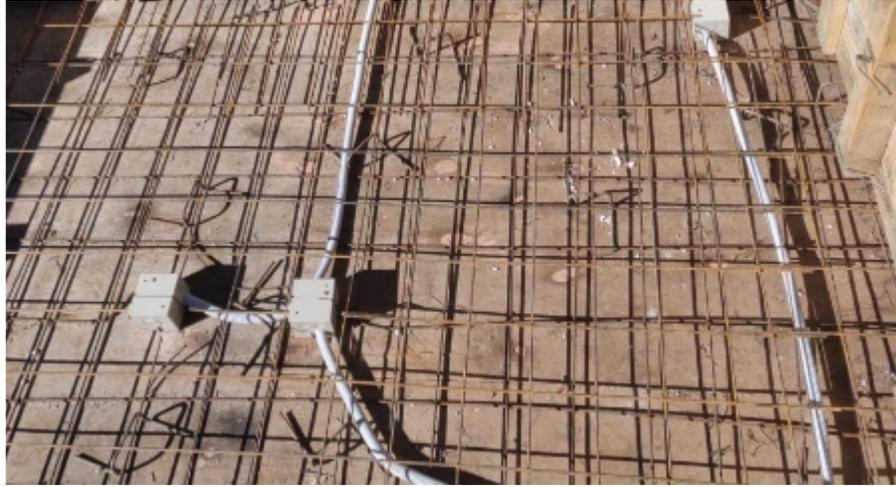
Cajas de iluminación, conectadas mediante caño corrugado.
